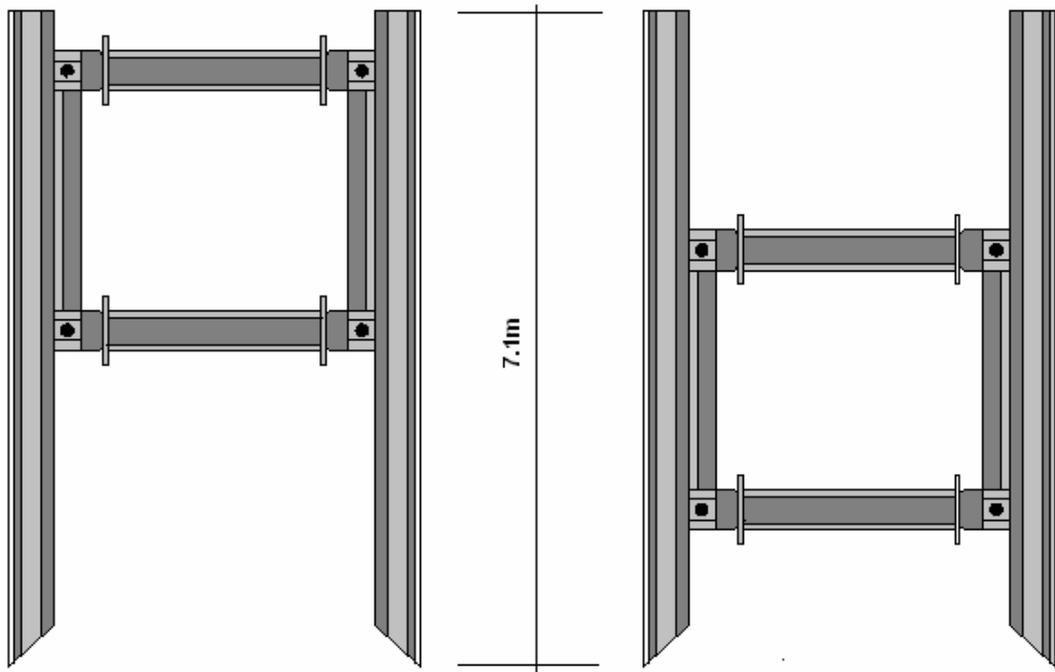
Vista Frontal Entibaciones Metálicas, Sistema Paralelo designando las posibles posiciones del Carro Móvil ./Elaboración Propia
